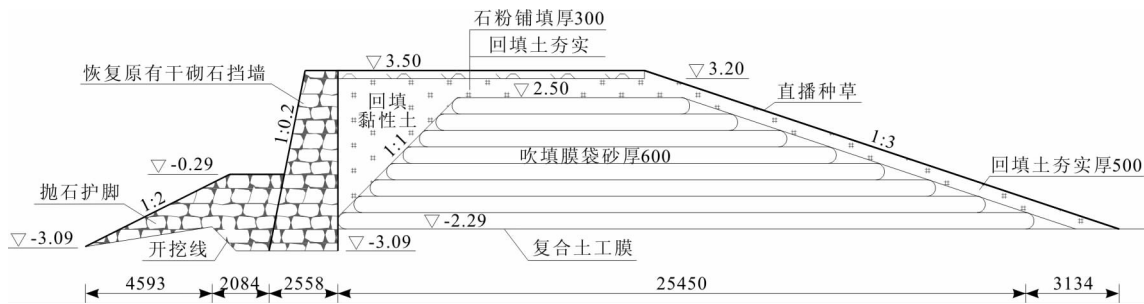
广东省某损毁堤防修复后横断面图(高程单位:m,标注单位:mm)
